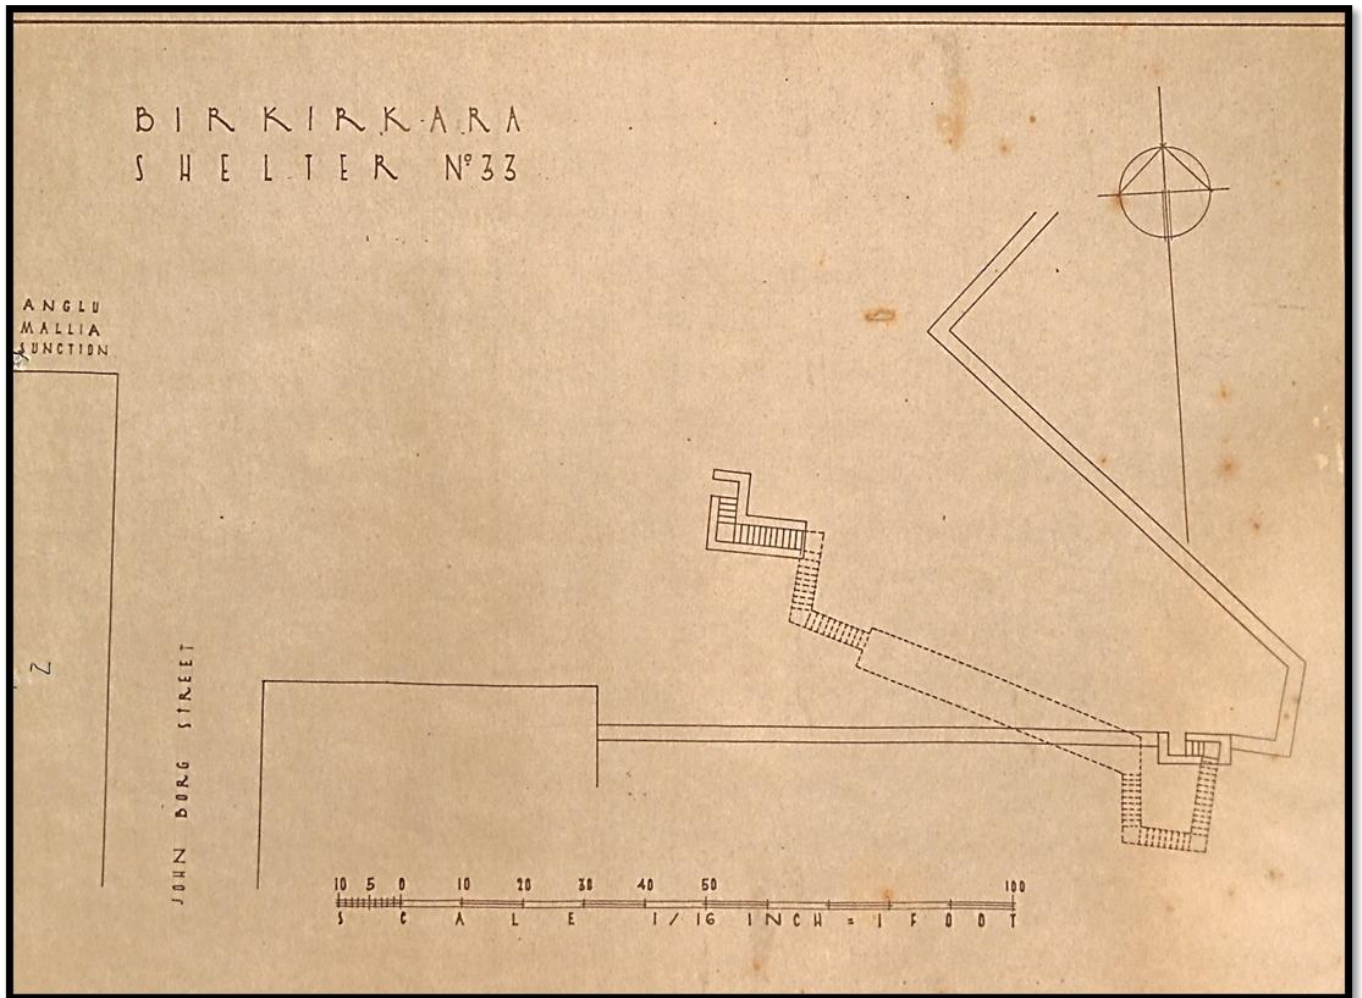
Planta do Abrigo nº33 "John's Borg Street – Anglu Mallia Junction"
